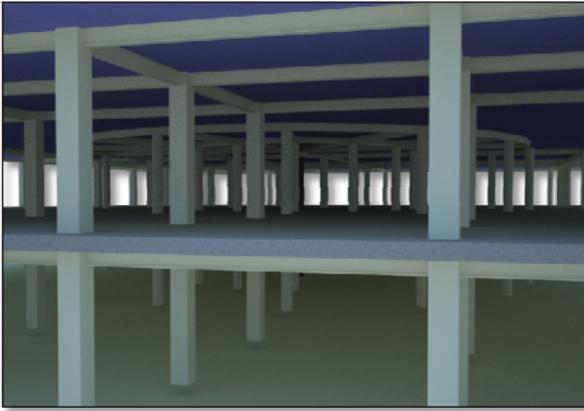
Elementos estructurales usados en el proyecto, principalmente vigas y losacero.
